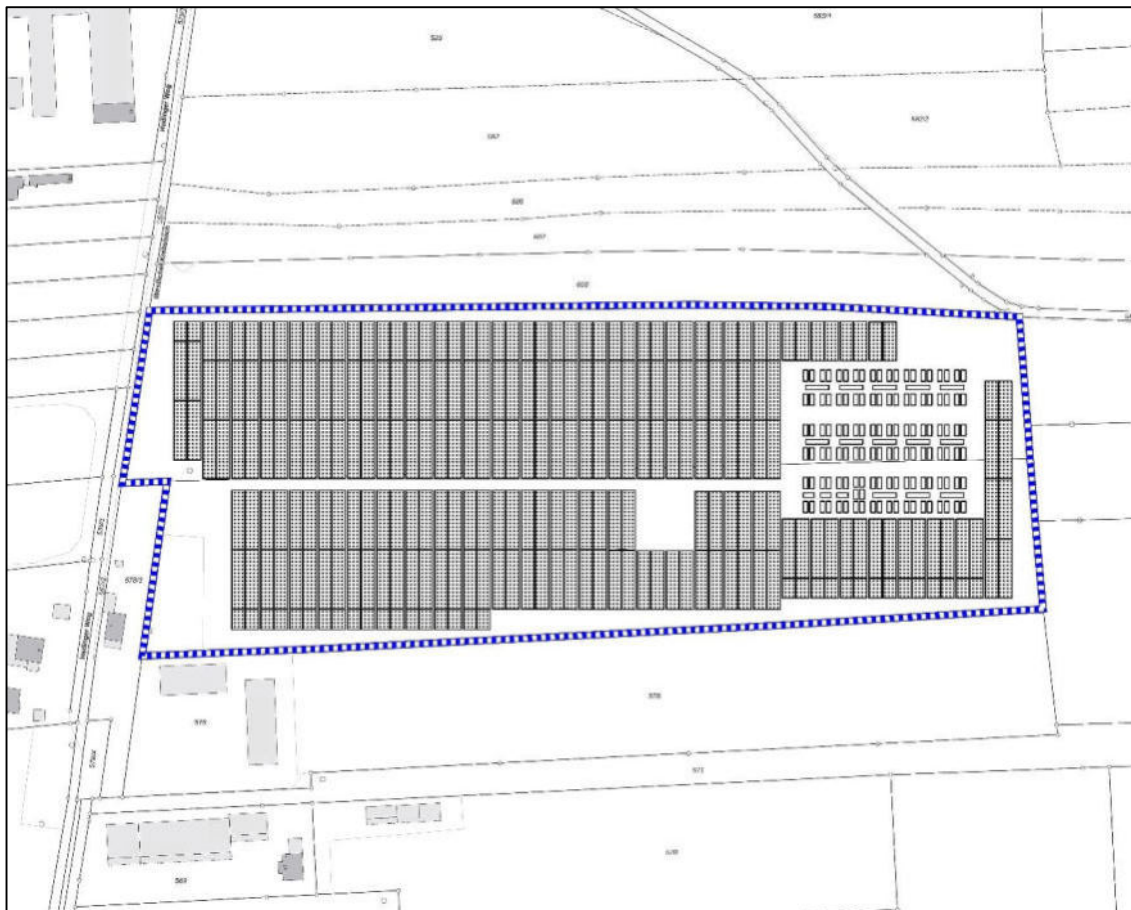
Lageplan der geplanten PV-/Batteriespeicheranlage mit Darstellung des vorgesehenen Geltungsbereiches/7/
